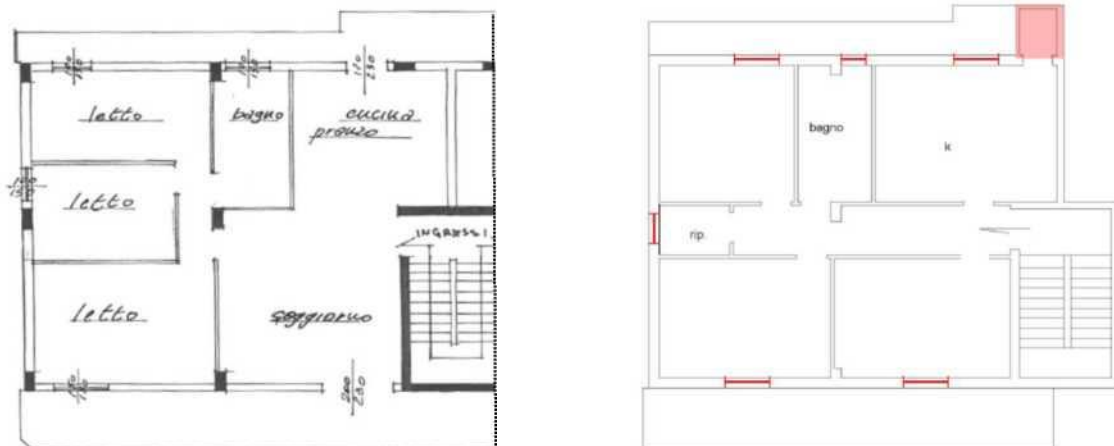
Appartamento piano terzo sub 12 - Confronto tra la planimetria “assentita” e stato di fatto.
